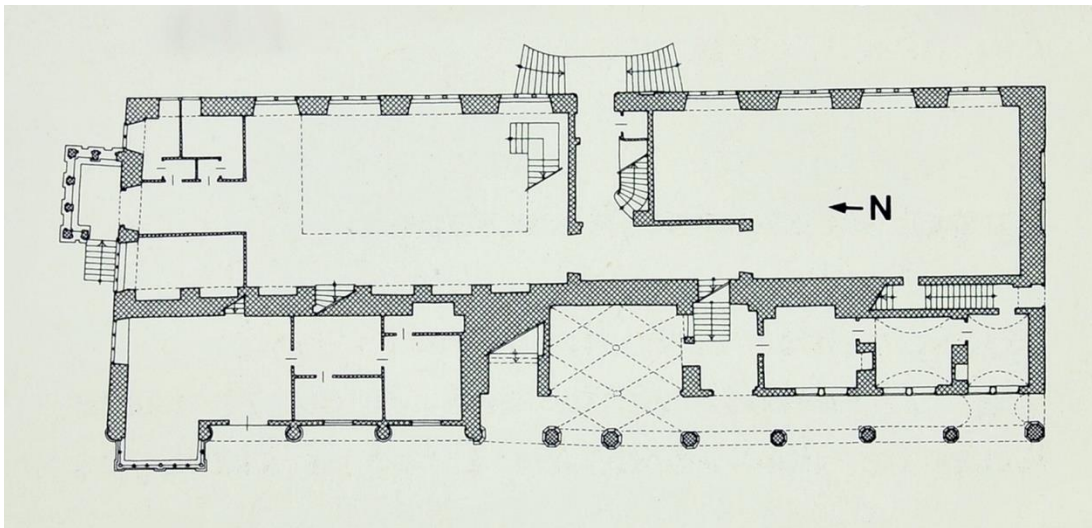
Rathaus Lemgo, Grundriss, Erdgeschoss (Stadtarchiv Lemgo, K 825)
